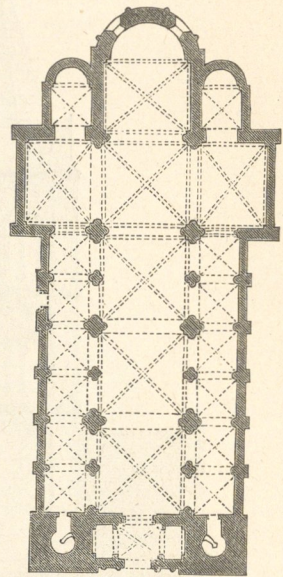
S. Fides zu Schlettstadt. Grundriß.
